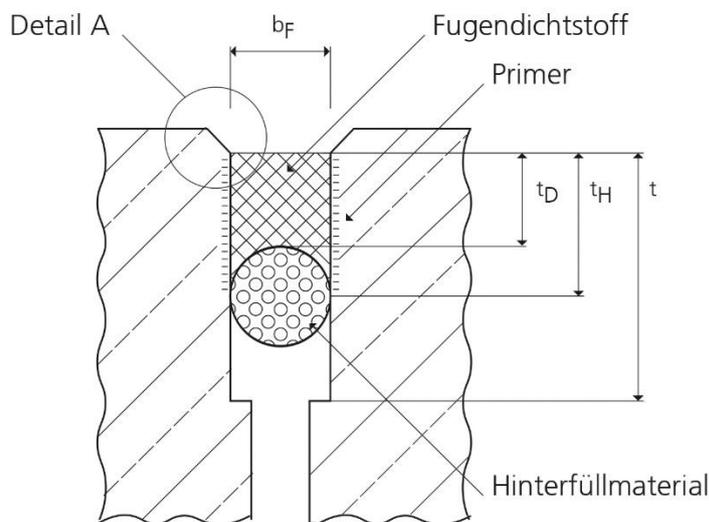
Befahrbare Fugenkonstruktion, Kontaktfläche Stahlbeton.
